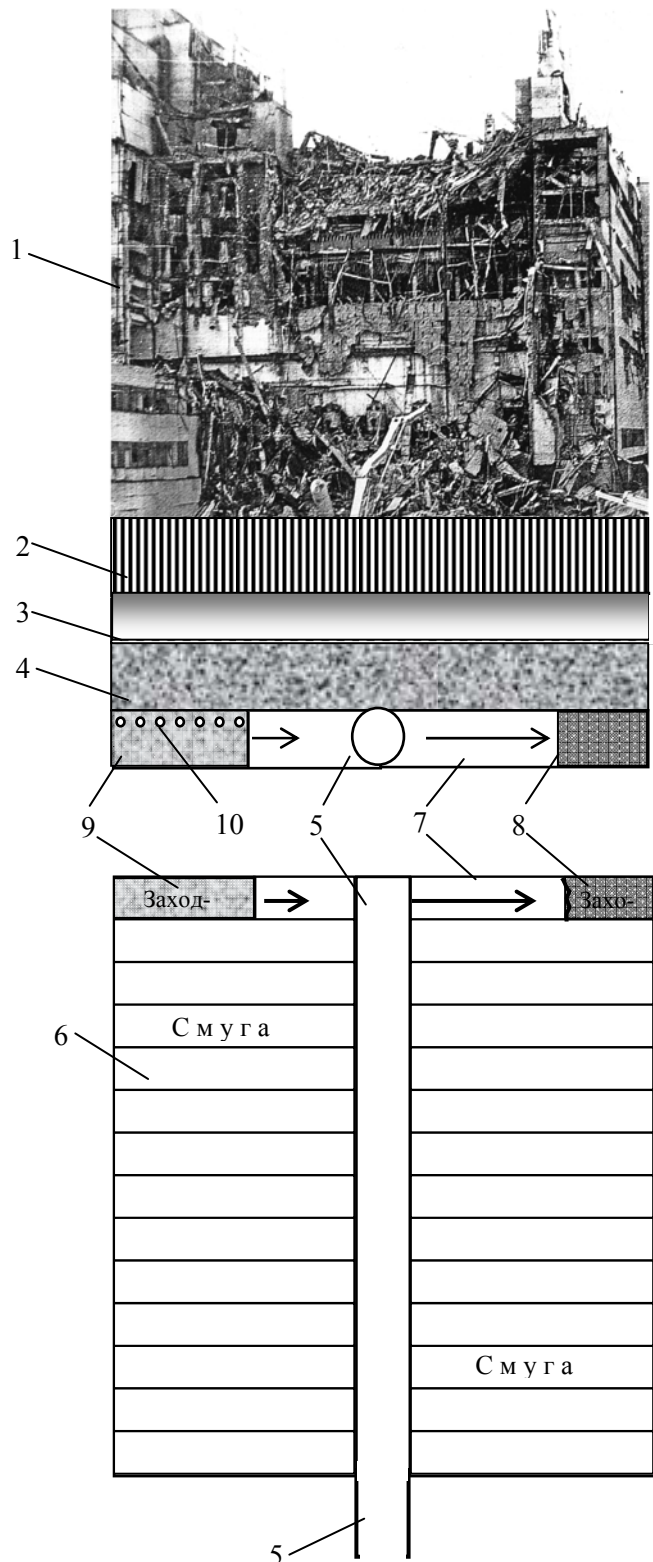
Схема розрізу і плану спорудження охолоджувальної плити - подушки: 1 – зруйнований блок; 2 – реактор; 3 – барботер з водою; 4 – фундаментна плита блоків №3 і №4; 5 – розкриваюча виробка (штольня); 6 – охолоджувальна плита-подушка; 7 – смуга; 8 – заходка виїмки ґрунту; 9 – заходка бетонування; 10 – реєстри теплообмінника
